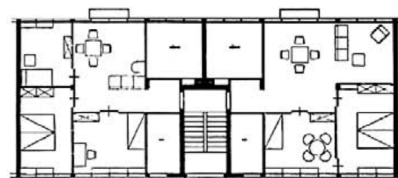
y 93. Planta e Imagen de Weissenhofsiedlung de Stuttgart por Mies Van der Rohe. 1927
